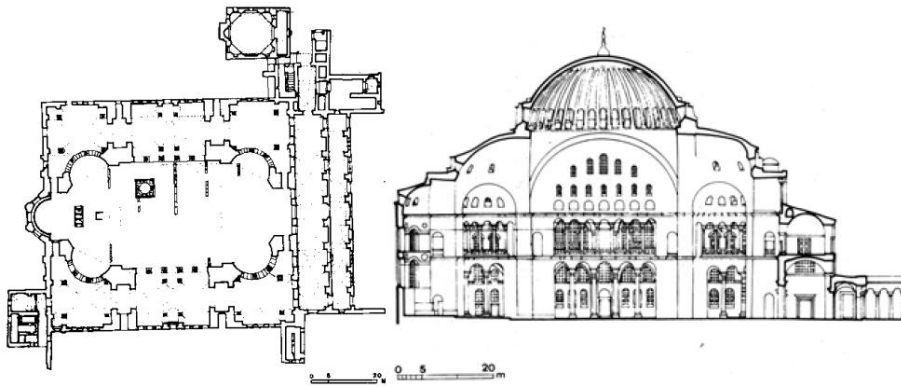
Pianta e sezione della chiesa di Santa Sofia a Istanbul. (Mango, C., 1978)
